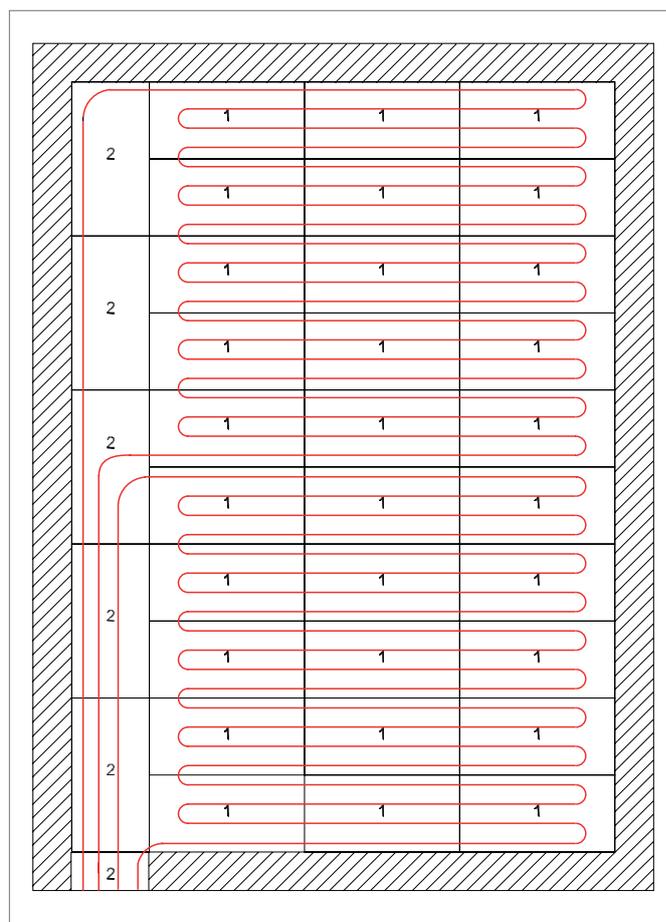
Exemple d'un plan de pose pour un système sec TS-14
